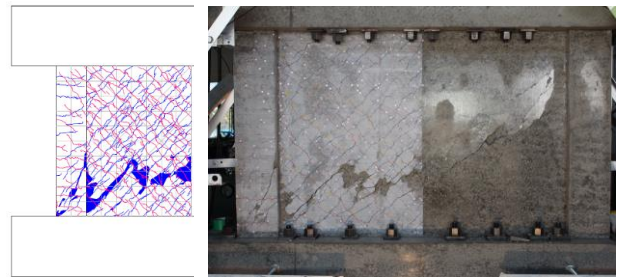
最終破壊写真とひび割れ図(S-D0)
